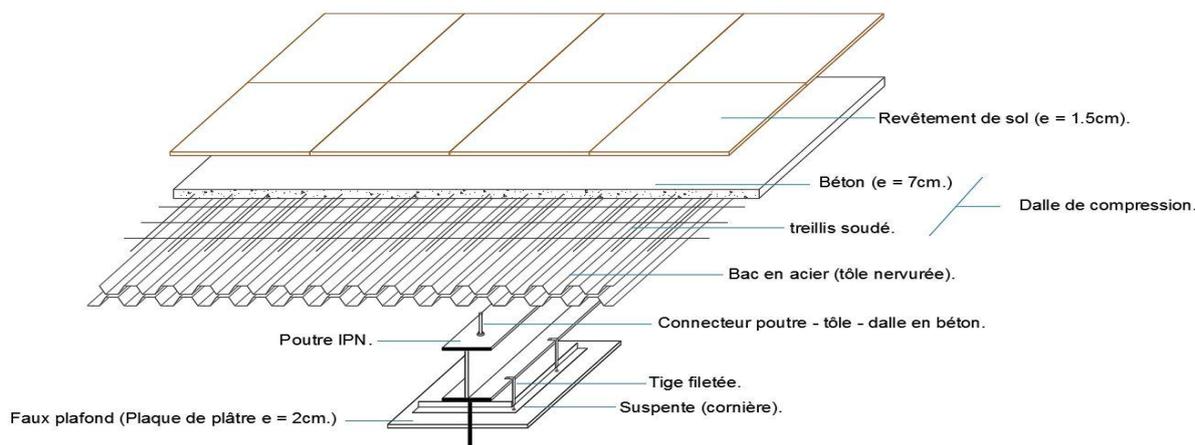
Détail Plancher collaborant (1/25) Source : les auteurs 2019
